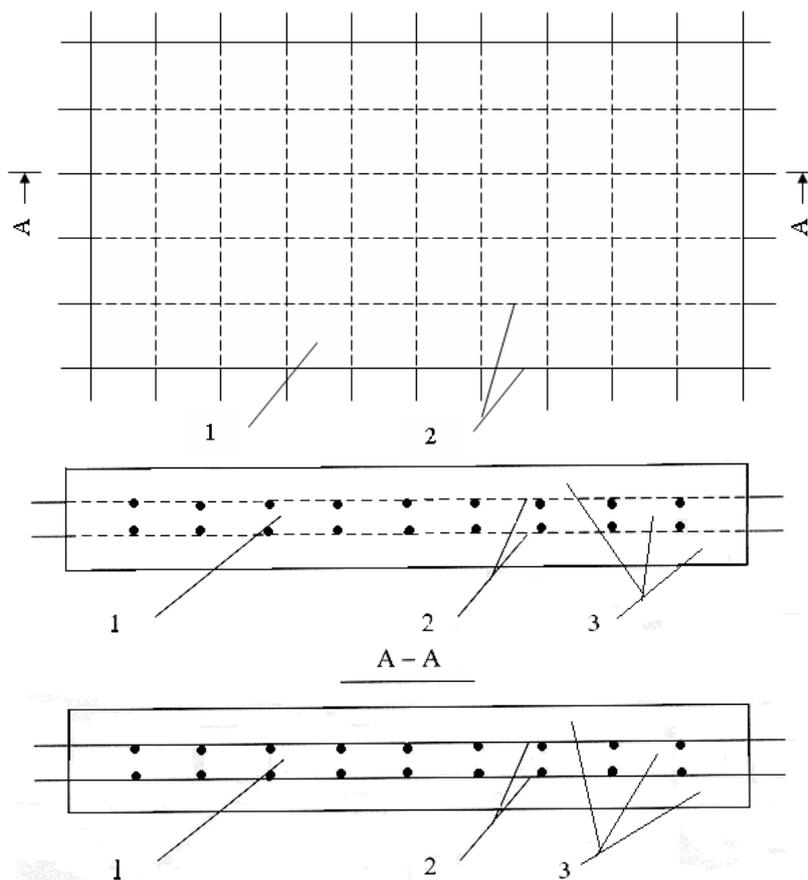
Плита сборного покрытия из асфальтобетона, армирована не менее чем двумя слоями полимерной арматуры: 1 – ячейка арматурной решетки; 2 – арматурная решетка из полимерных материалов; 3 – наполнитель из асфальтобетонной смеси
